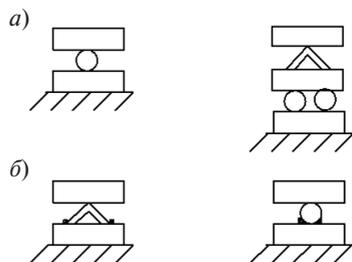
Схема подвижных (а) и неподвижных (б) опор для испытания изгибаемых конструкций
